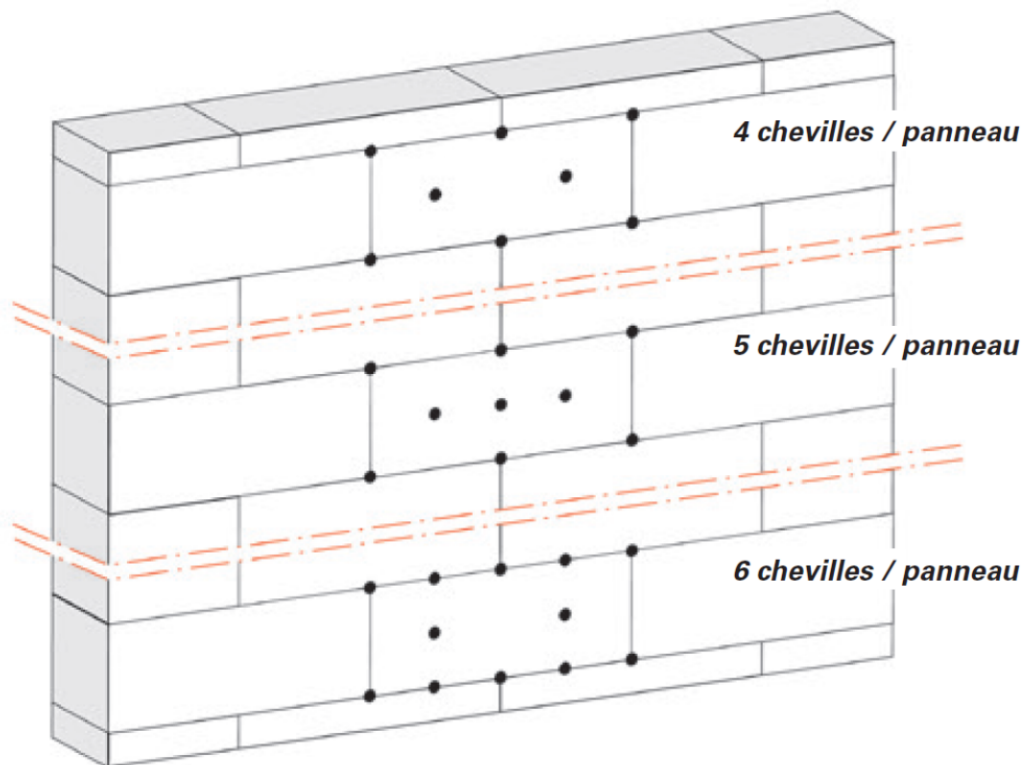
Fixation des panneaux isolants par chevilles ou clous – Disposition en plein et en joint (exemples)
